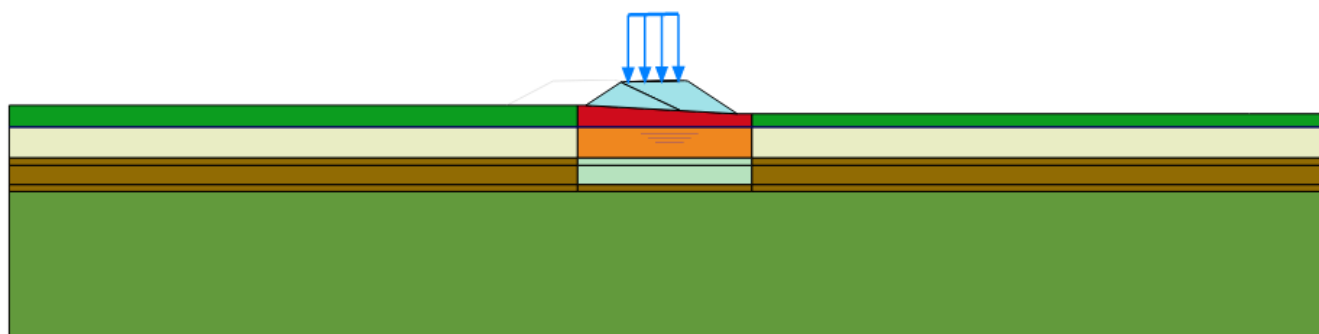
Modello rilevato Sez. 27 di IV01 – con interventi
